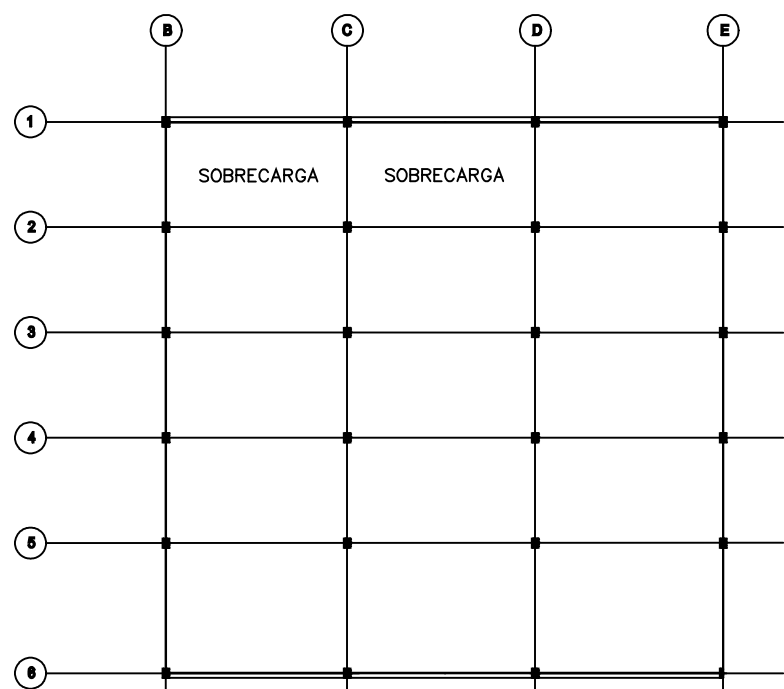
Primeira posição da sobrecarga na laje (SOB2-)
